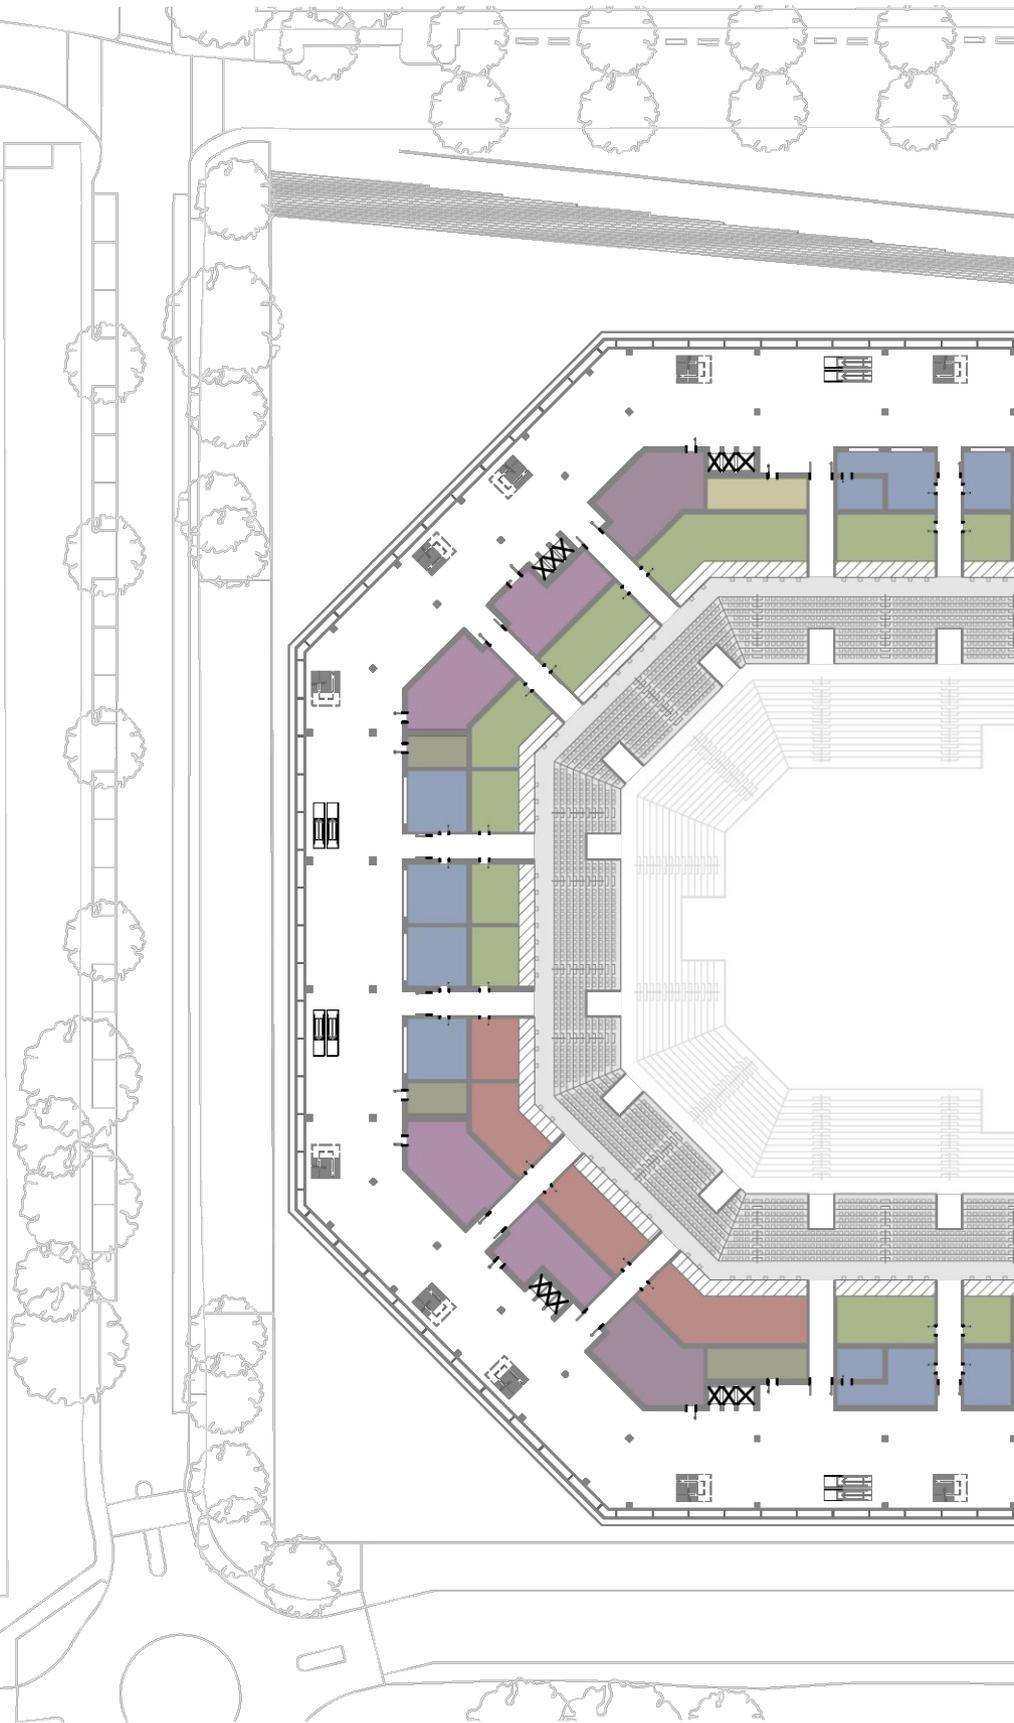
Grundriss 2. OG Nutzungsverteilung
